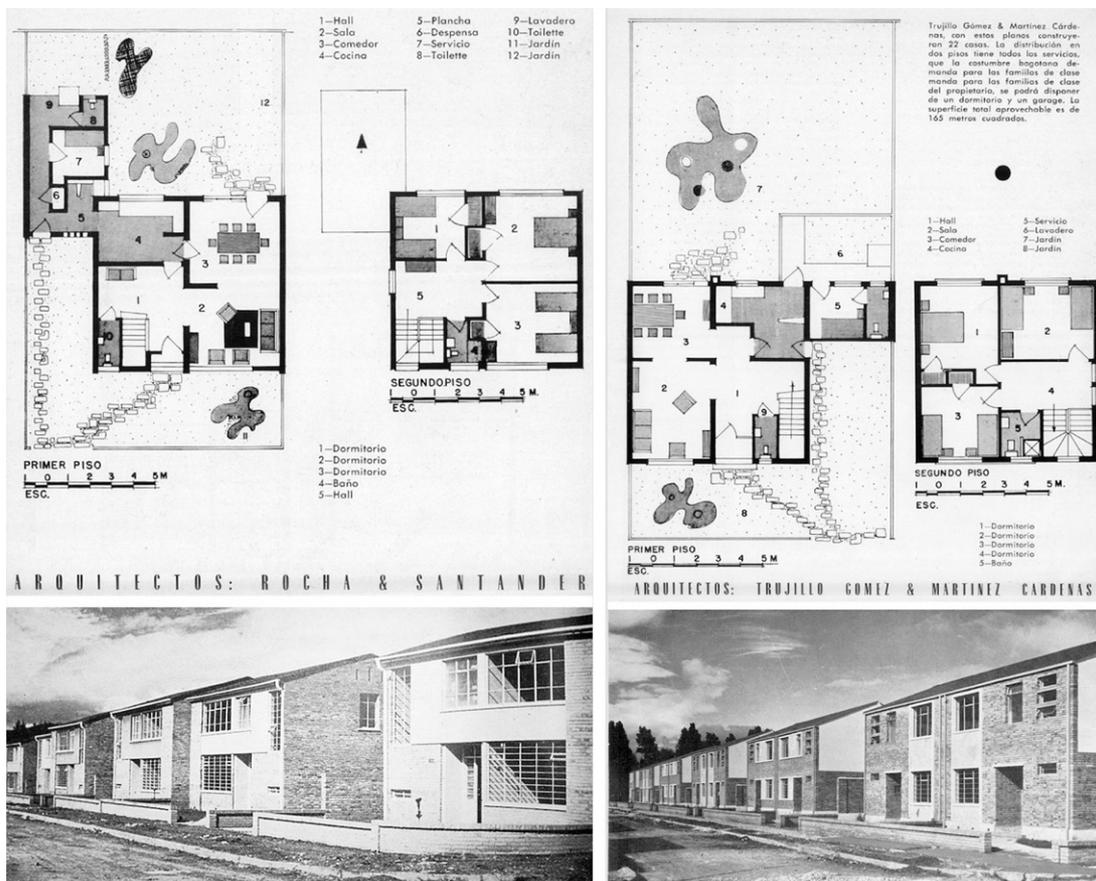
Casas tipo RS y TGM Los Alcázares. Revista PROA, (1949, octubre) 28, s.p.
